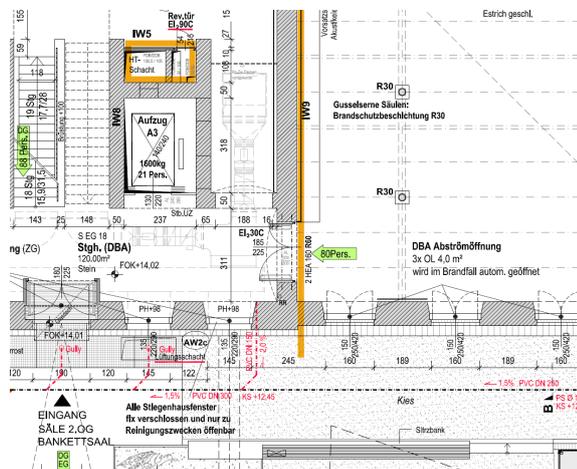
Planausschnitt Bestandsplan SEG23_2
